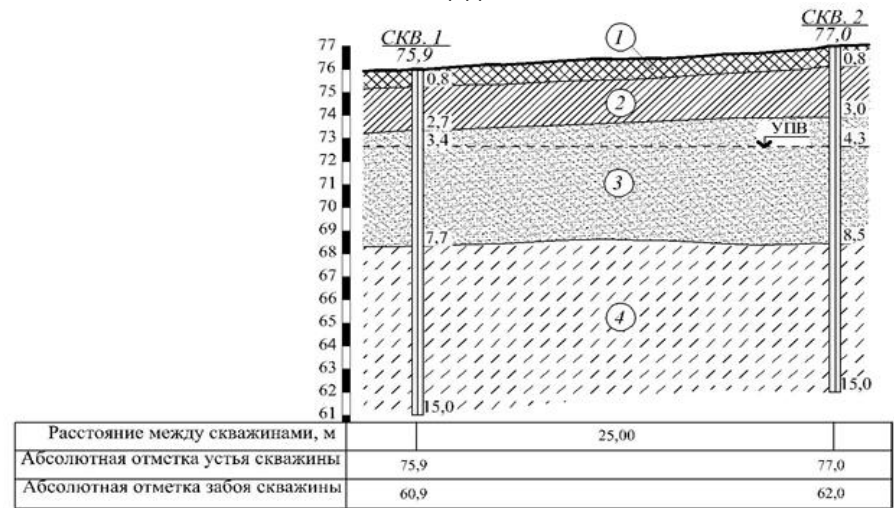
Схема инженерно-геологического разреза строительной площадки (по скважинам 1 и 2):
